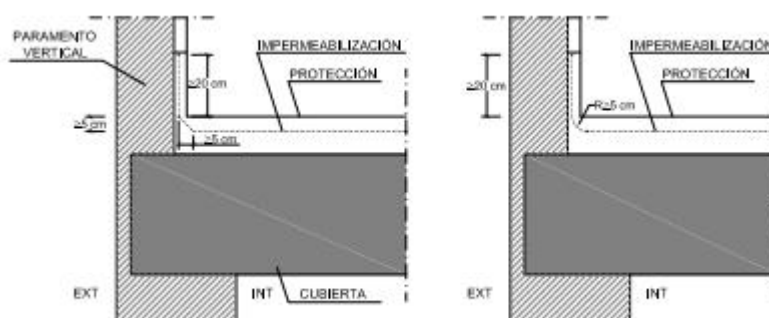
Encuentro de la cubierta con un paramento vertical
